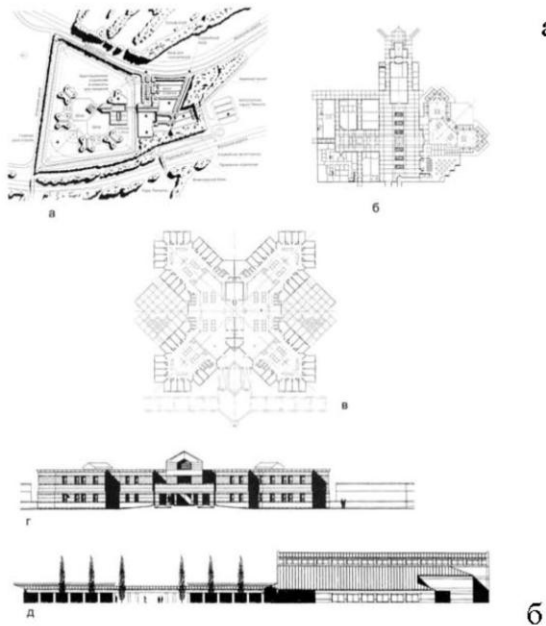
Окружна виправна колонія у м. Контра-Коста, штат Каліфорнія, США: а - схема генерального плану; б - план громадського корпусу; в - план житлової будівлі; г, д - фасади
